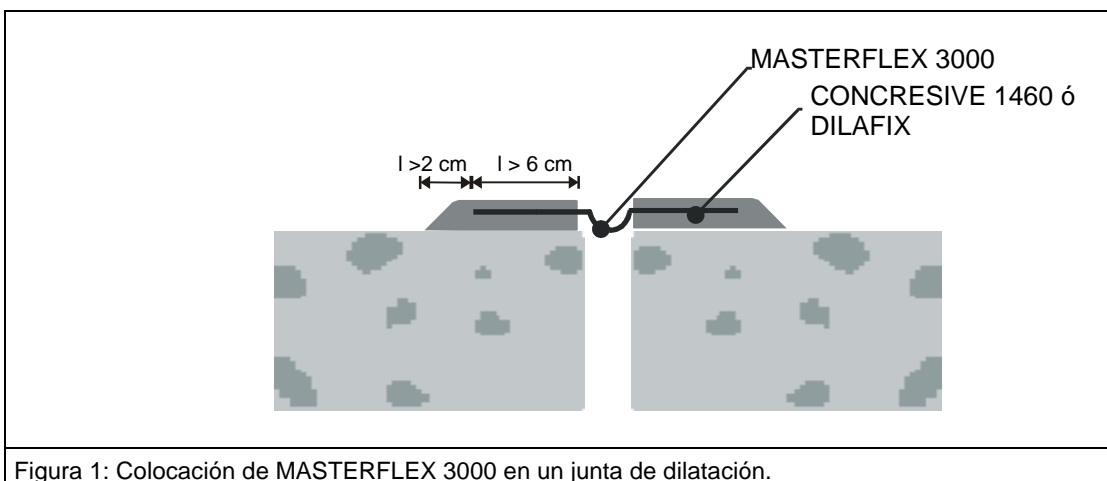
Colocación de MASTERFLEX 3000 en un junta de dilatación.
